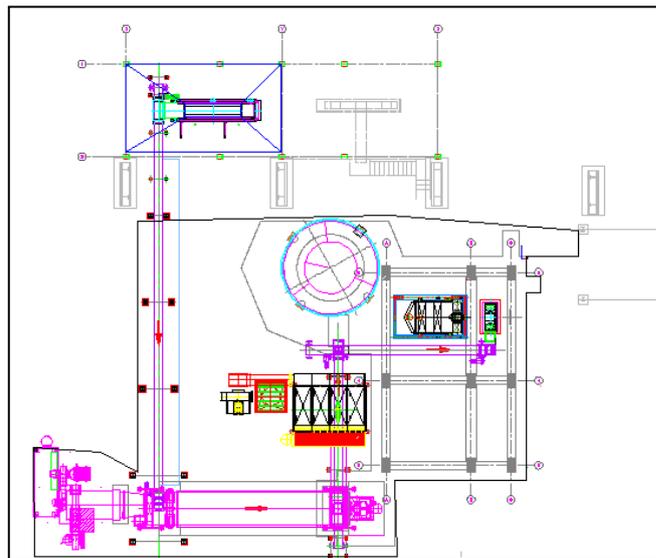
PLANTA DE DESEMPOLVADO (FILTRO DE SECADOR).¹
